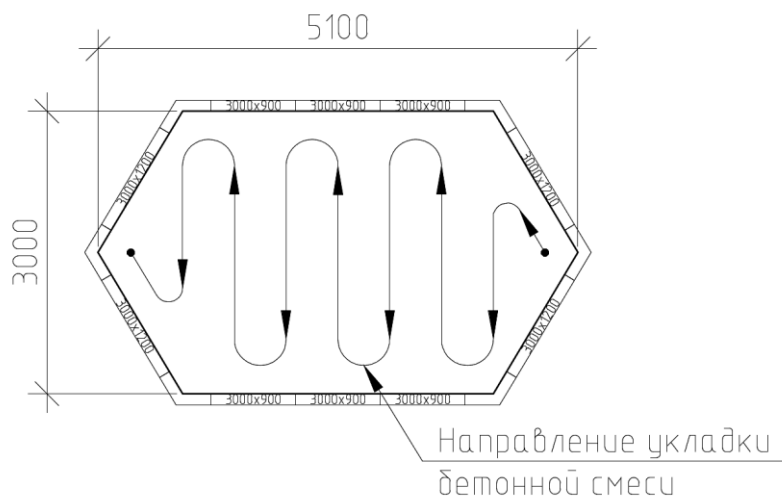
Схема и направление движения бетоновода при укладке бетонной смеси при бетонировании захваток стоек
